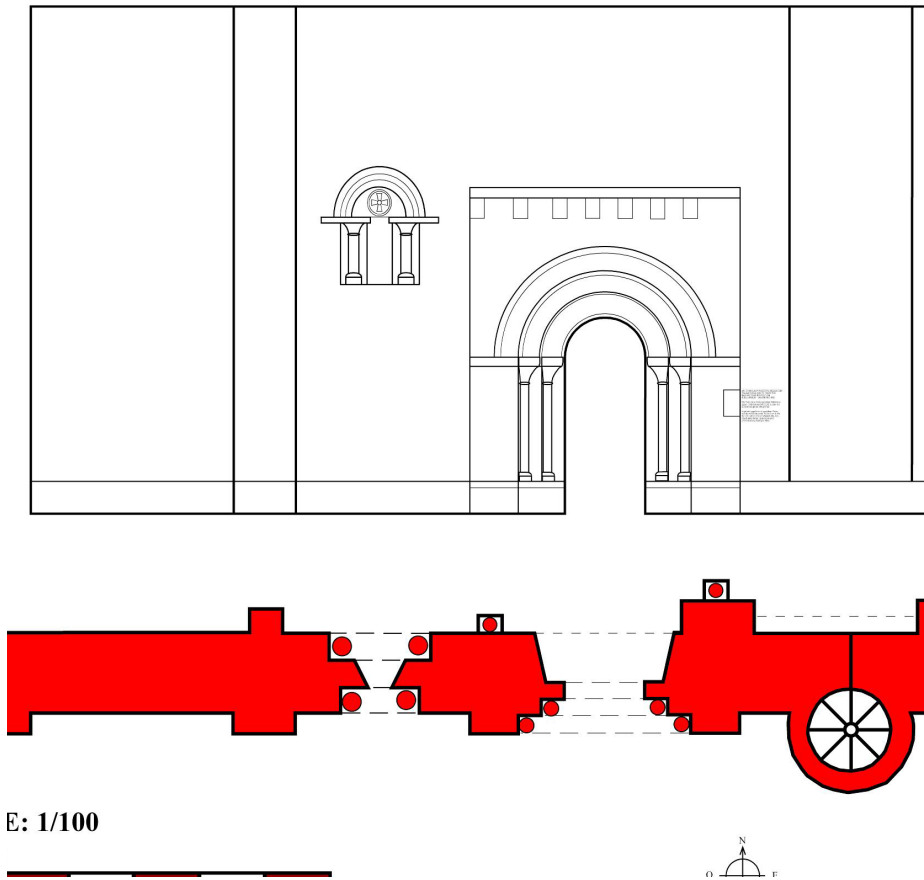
Alzado y planta de la fachada sur del templo de San Miguel (F. Palomero).
